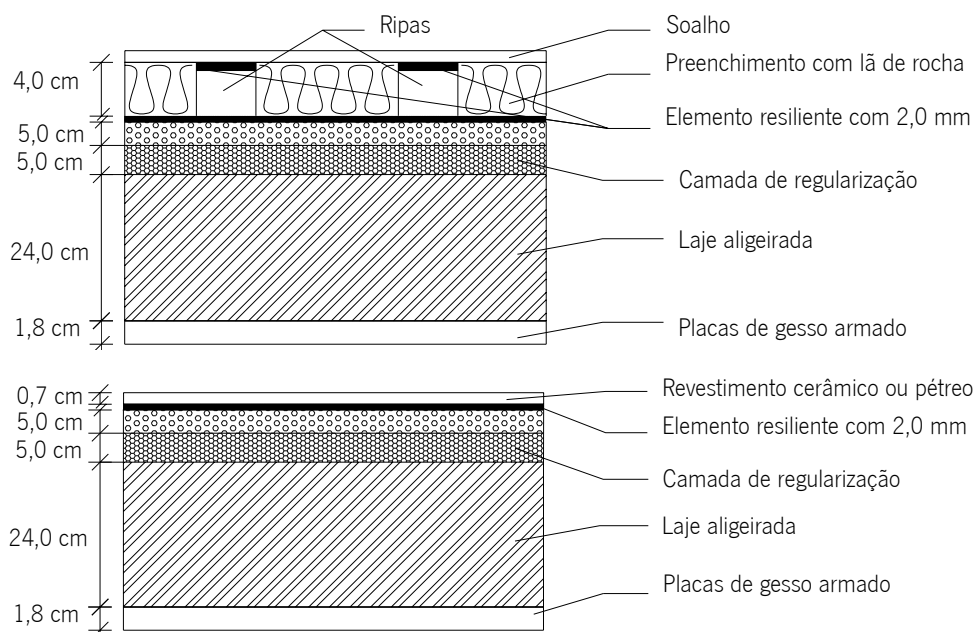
Pavimento de separação entre duas habitações com soalho de madeira e com material cerâmico ou pétreo – Pav1
